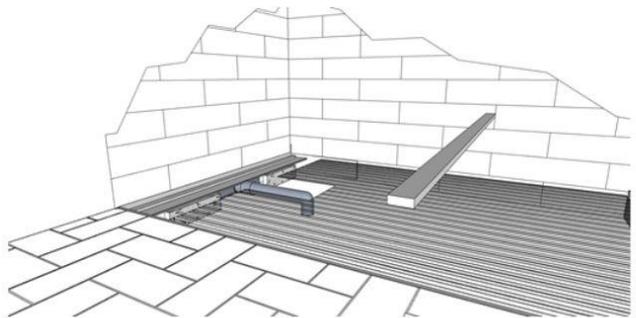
Colocar el listón de tolerancia en posición horizontal sobre el sumidero en su parte trasera cubriendo el canal de drenaje, haciendo de tope en la posición del plato
